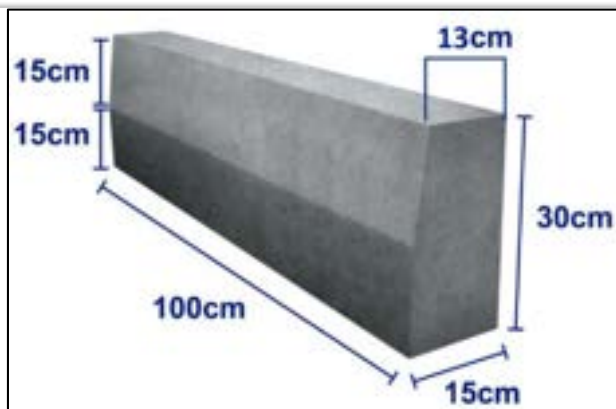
Modelo de Meio-fio de Concreto Pré-Fabricado
